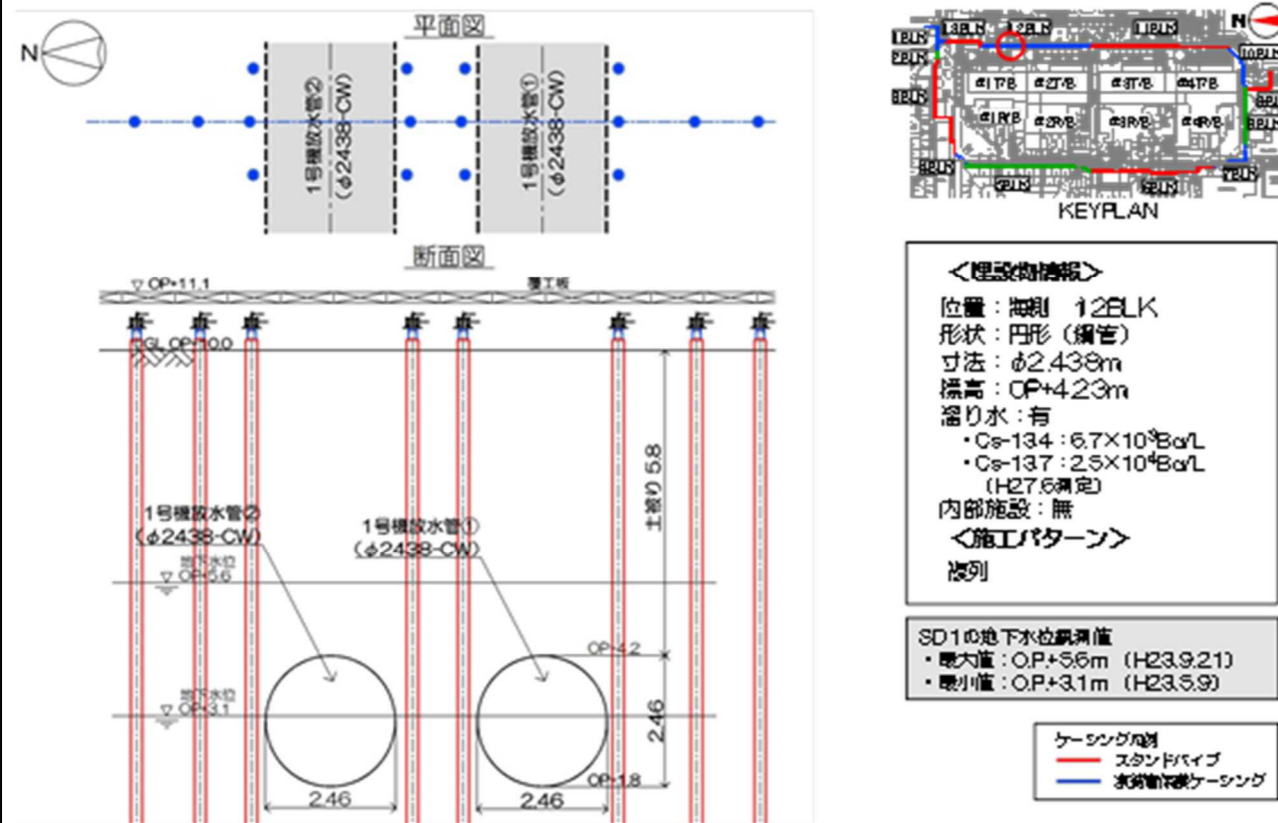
【12-7】1号機放水管①② 施工方法 (複列施工)
